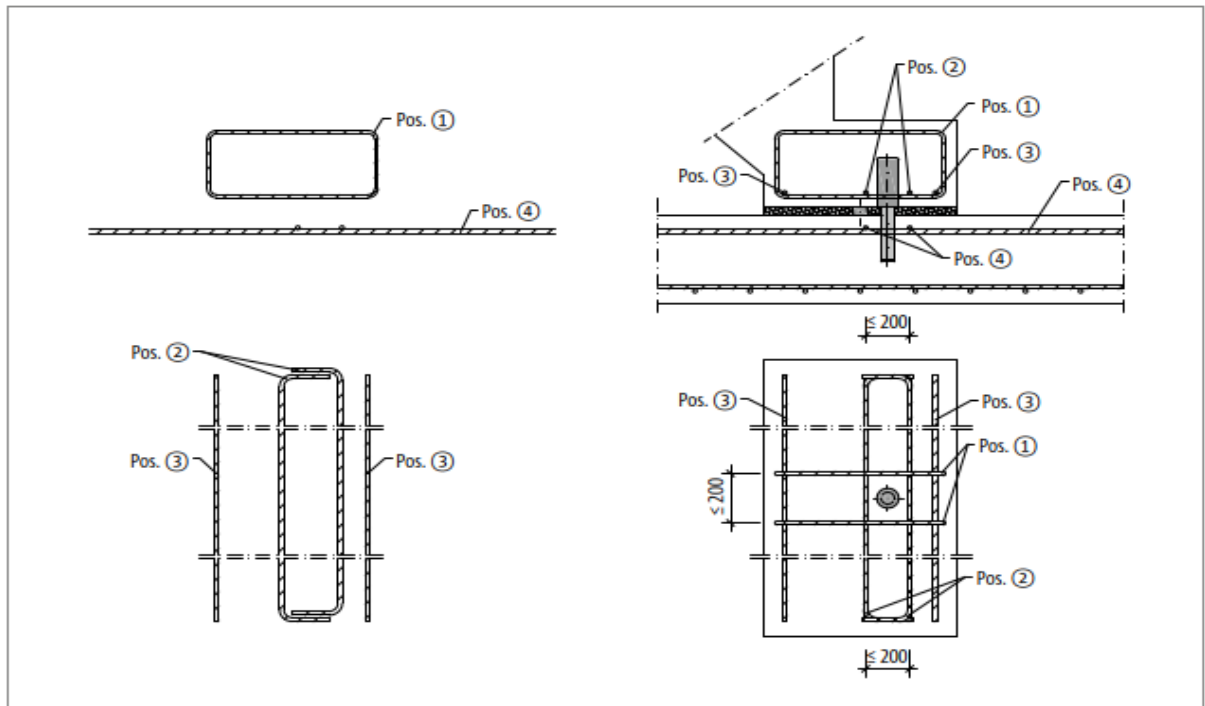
Schöck Tronsole® Typ D: Bauseitige Bewehrung
